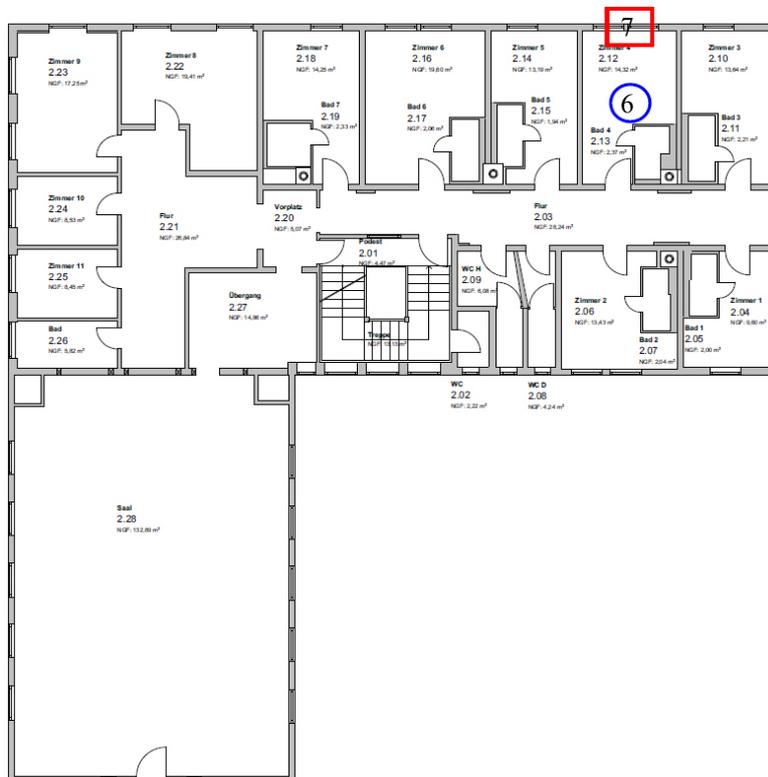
Lage und Nr. der Bauteilöffnung an der Decke über OG (blau: Deckenöffnung, rot: Auflageröffnung)
